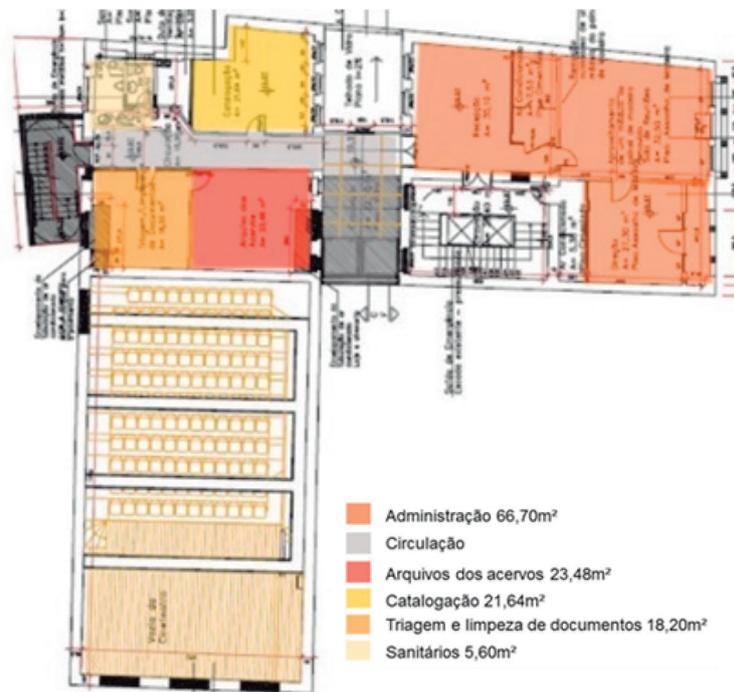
Planta baixa do quarto pavimento do Centro Cultural Erico Verissimo. Porto Alegre, 2016.
